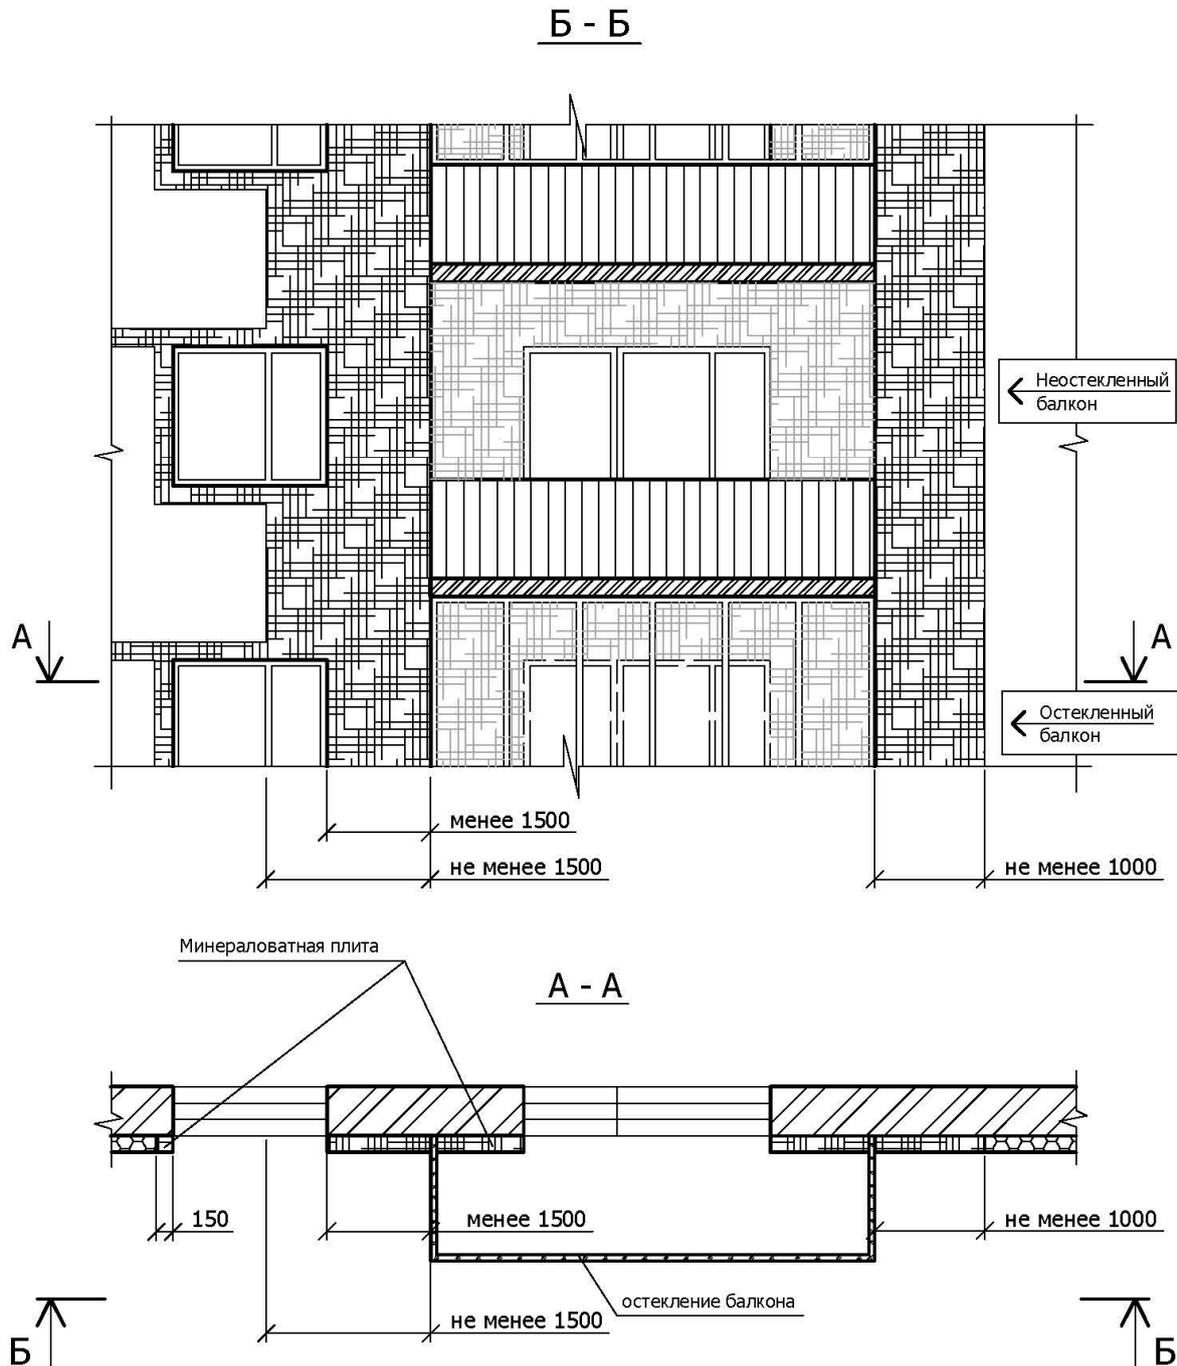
Внутренний угол, образуемый ограждением балкона и стеной (менее 1,5 м)
